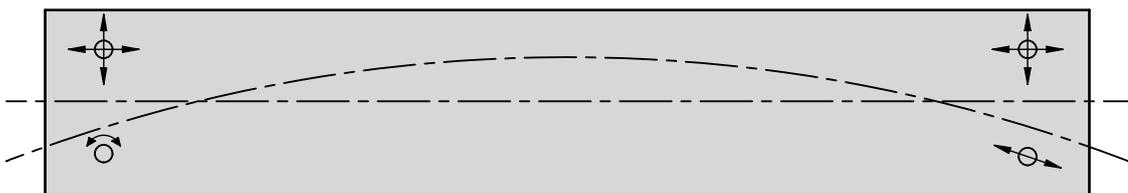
Lagerungsschema eines Brückentragwerks mit unterschiedlicher Tragwerks- und Gleisachse
